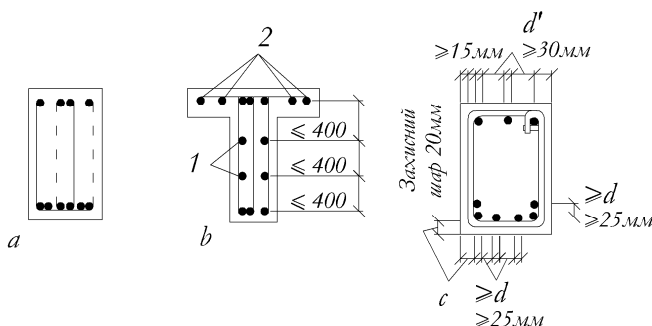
Поперечний переріз балок, армованими зварними та в'язаними каркасами: *a* - чотирьохвіткові хомути в'язаних каркасів; *b* - армування балок таврового перерізу; *c* - відстань в світлі між поздовжніми стержнями; 1 - арматура 10-12мм по боках граней балок; 2 - поздовжні стержні зварної сітки для армування полочки таврового перерізу
